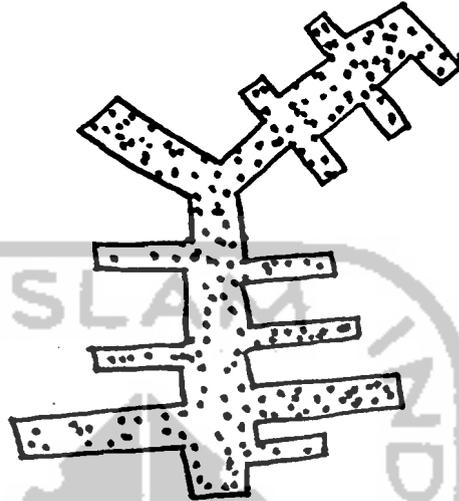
Tata Ruang dan Masa Bangunan.
